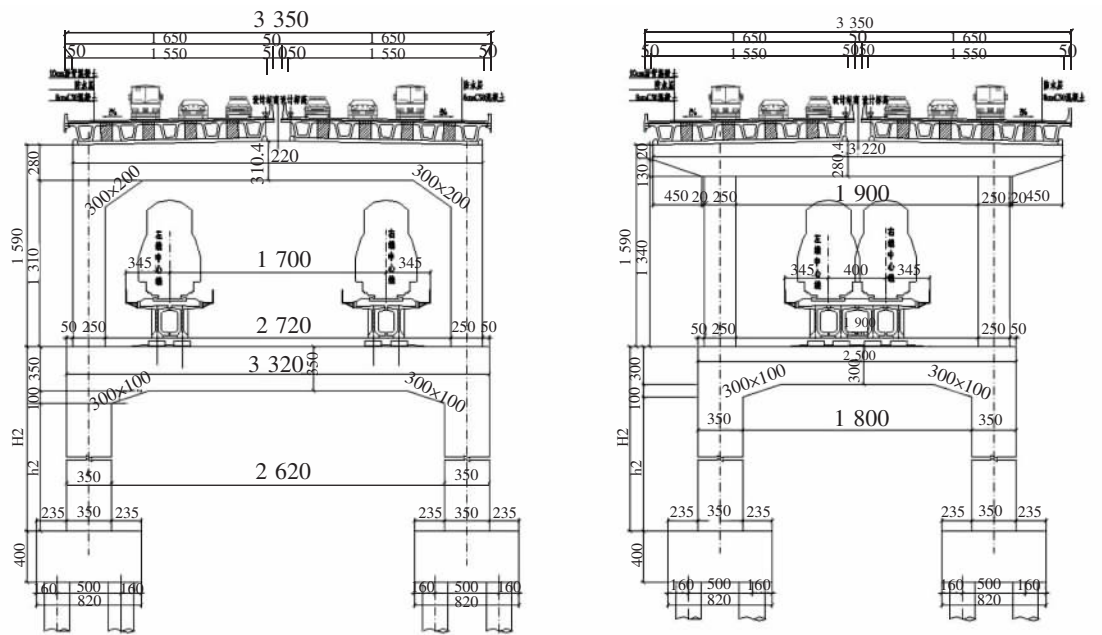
17 m 与 4 m 线间距对应的双层门式墩(单位:cm)
